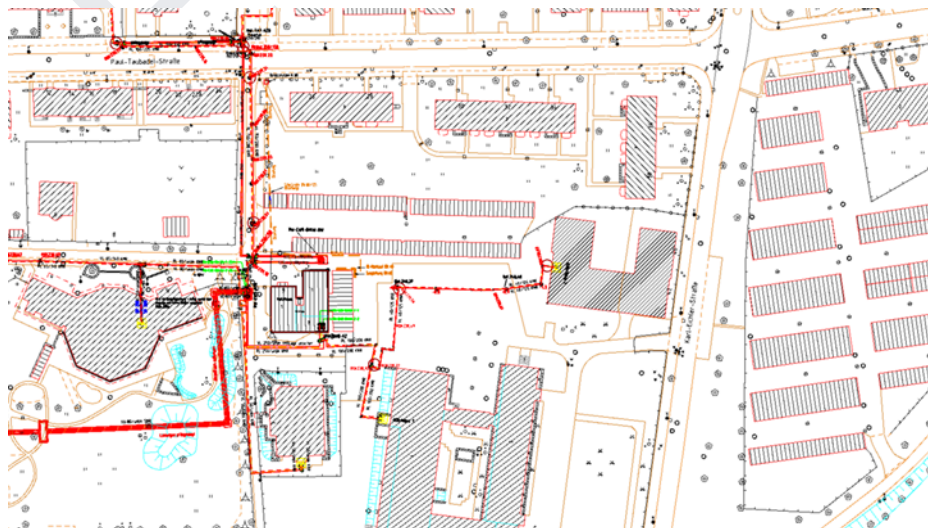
Geplante Anschlussstrasse des HKW Rauschwalde.
